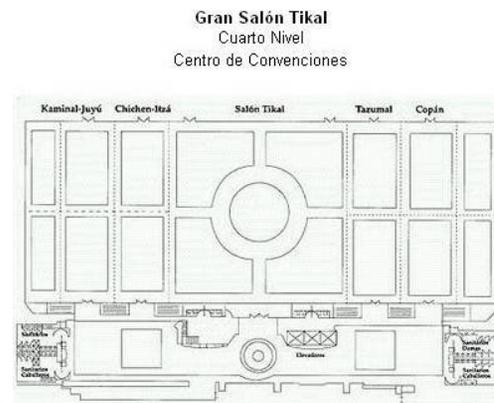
Planta de Centro de convenciones Grand Tikal Futura.
